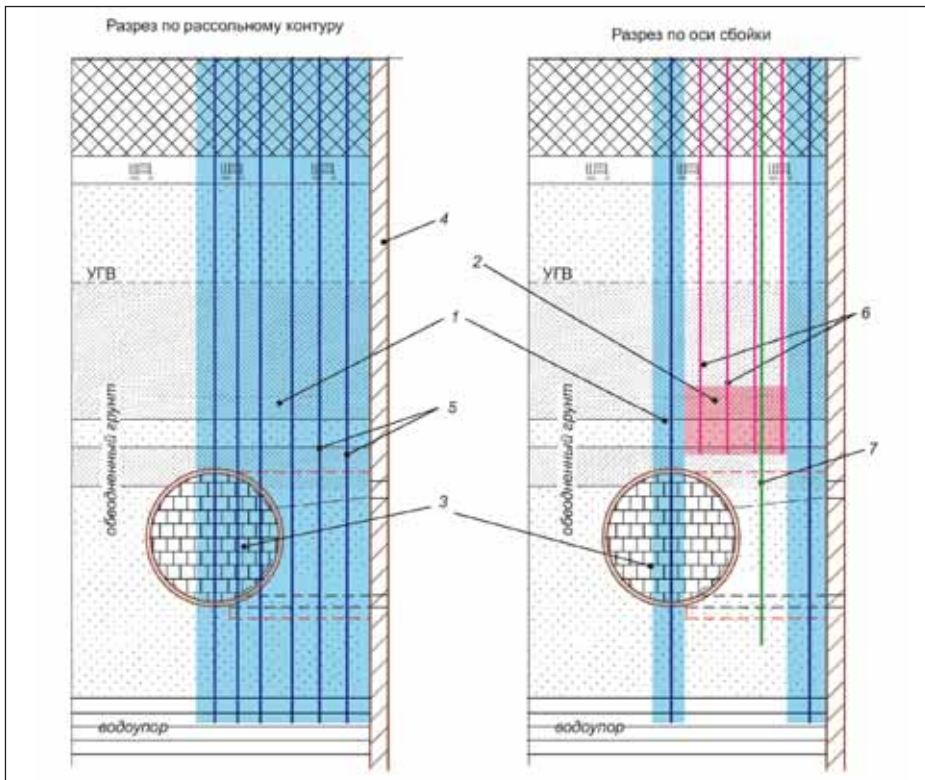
Рекомендуемый вариант замораживания: 1 – ледогрунтовое ограждение от рассольных колонок; 2 – ледогрунтовый массив, замороженный «сухим льдом»; 3 – забутованный участок тоннеля; 4 – ограждающая конструкция выработки; 5 – колонки для рассольного замораживания; 6 – колонки для замораживания «сухим льдом»; 7 – гидронаблюдательная скважина
